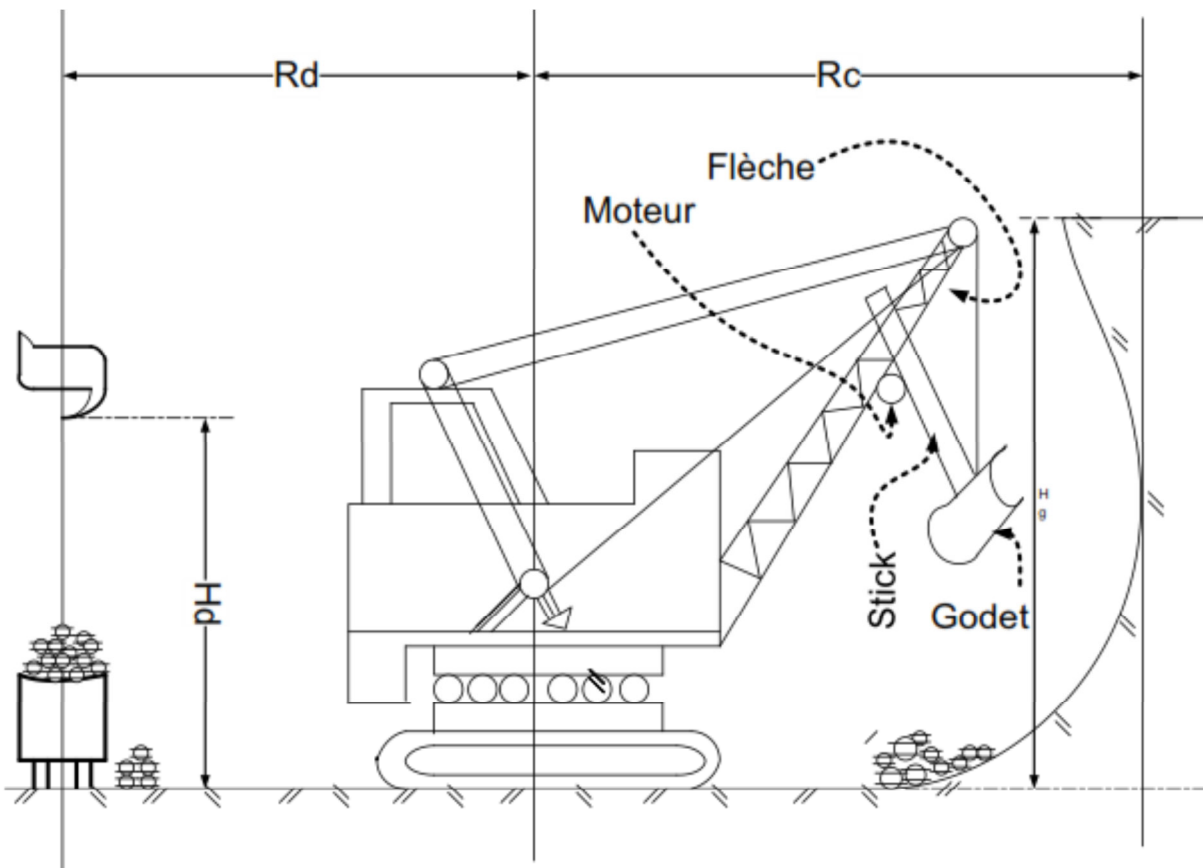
Principales dimensions de la Pelle à câble sur chenilles.[7]
